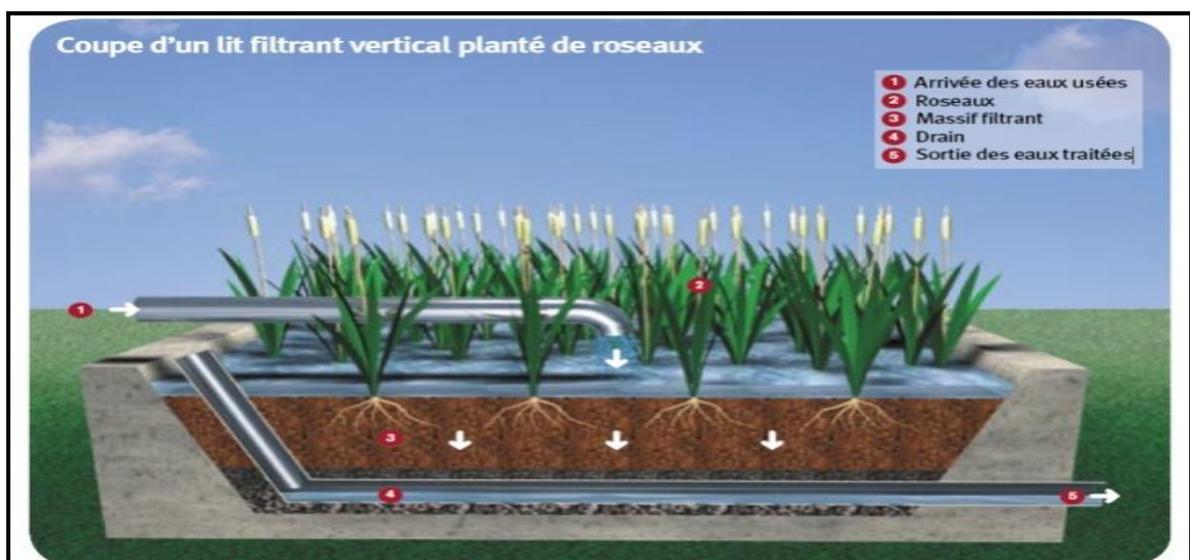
Une coupe d'un lit filtrant vertical planté de roseaux d'assainissement.
